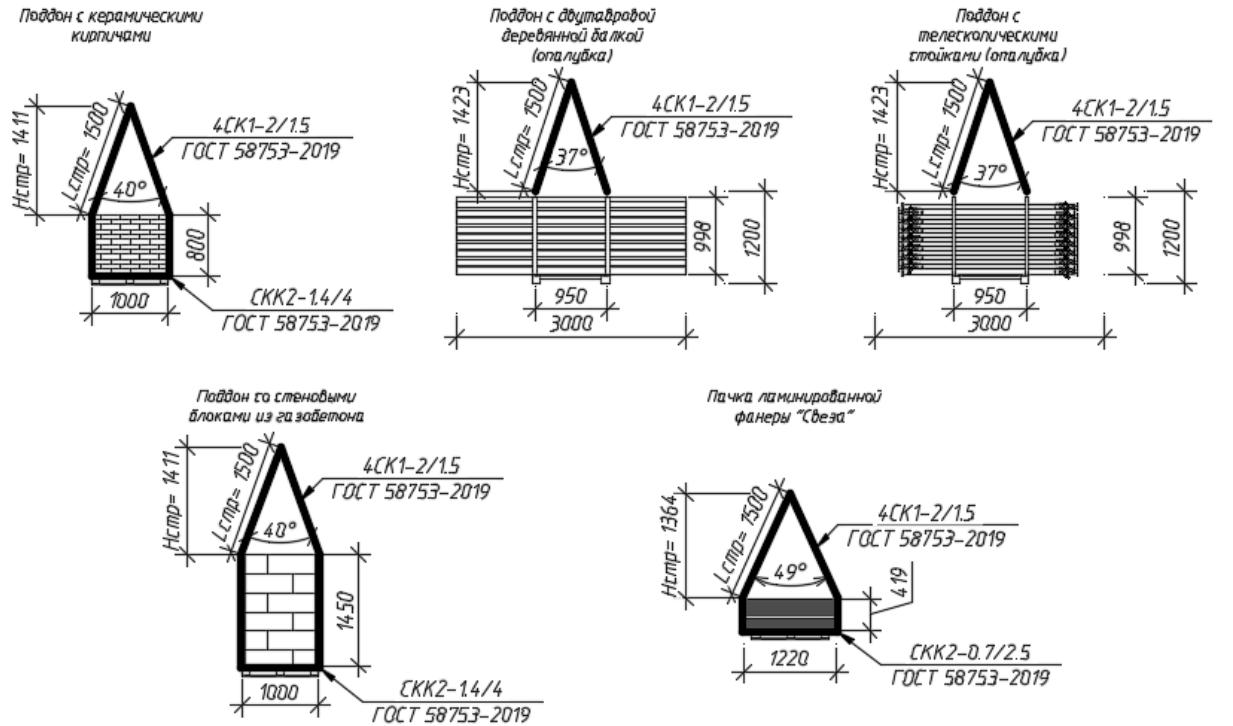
Определение длины стропов для поддона с керамическими кирпичами, поддона с двутавровой деревянной балкой (опалубка), поддона с телескопическими стойками (опалубка), пачки ламинированной фанеры «Свеза», поддона со стеновыми блоками из газобетона
